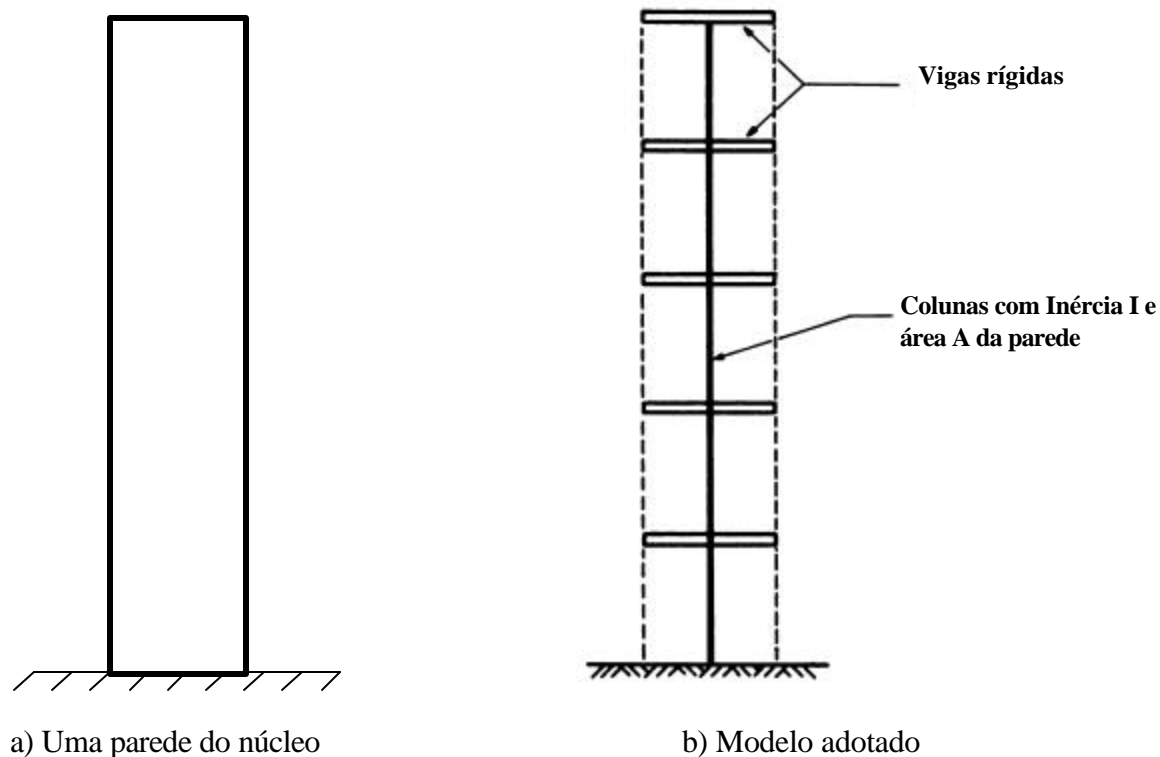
Discretização da parede do núcleo pelo modelo de coluna central
